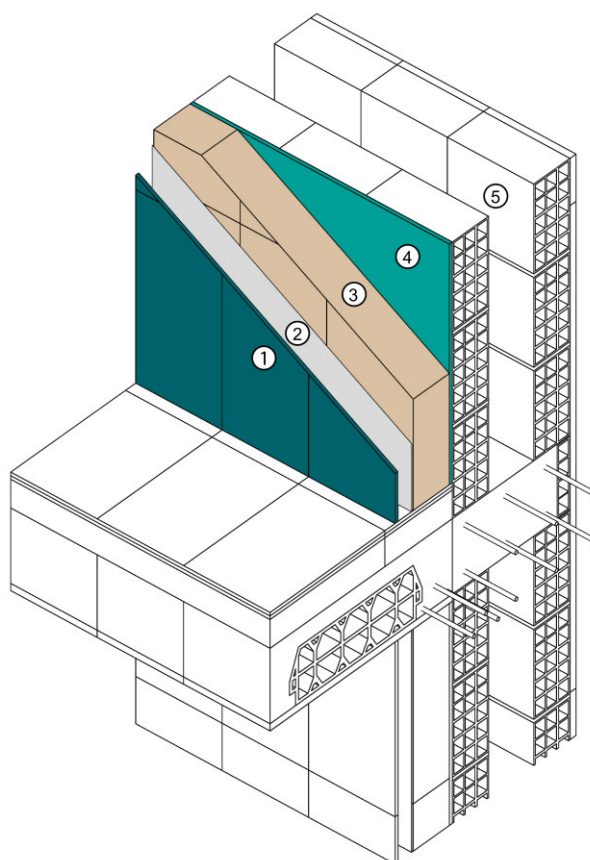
Schema costruttivo dell'intervento proposto (isolamento dall'interno)
